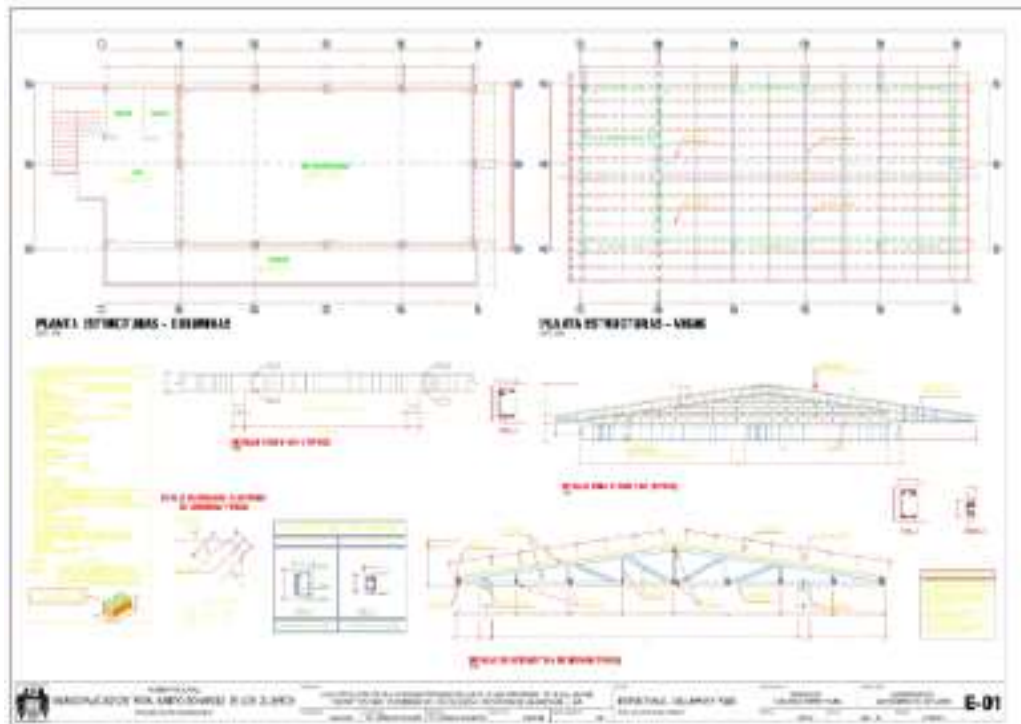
Plano de Estructuras (Fuente: Elaboración propia)
